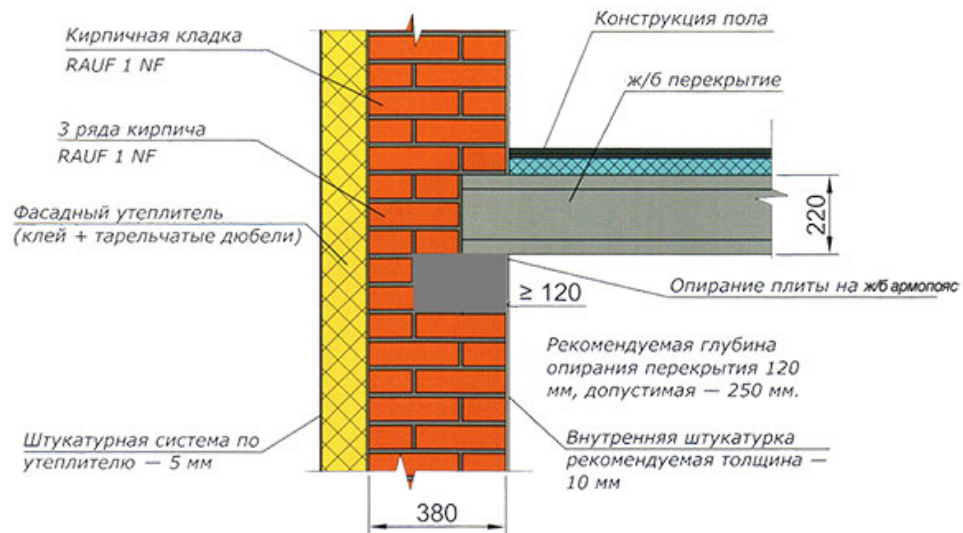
Операння залізобетонного переkritтя на зовнішню стіну.
